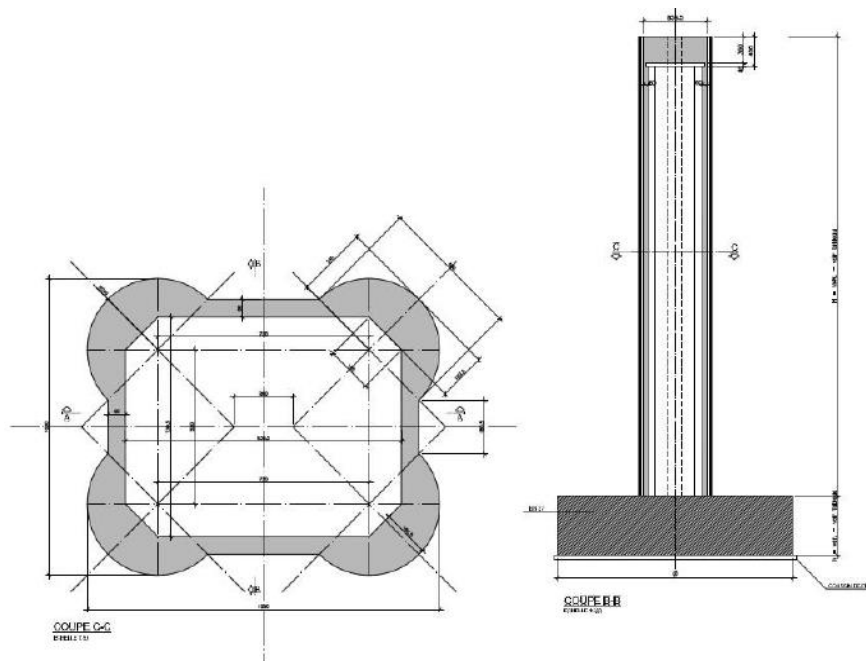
Piles de section constantes sur fondations superficielles (P1 / P14)
